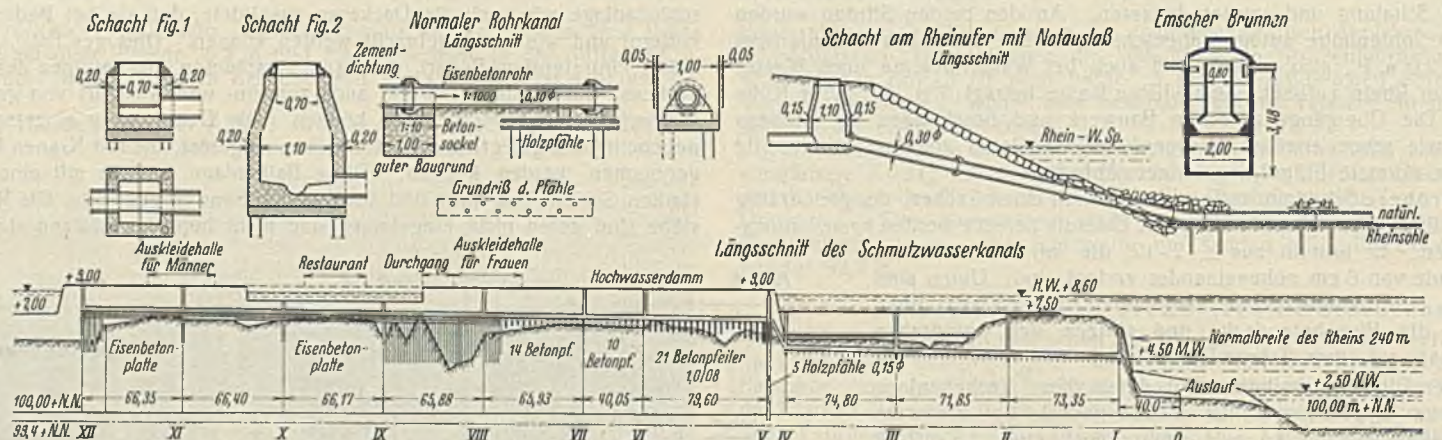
Entwässerungsanlagen (Lageplan vgl. Abb. 4). Maßstab 1 : 5000/500.
